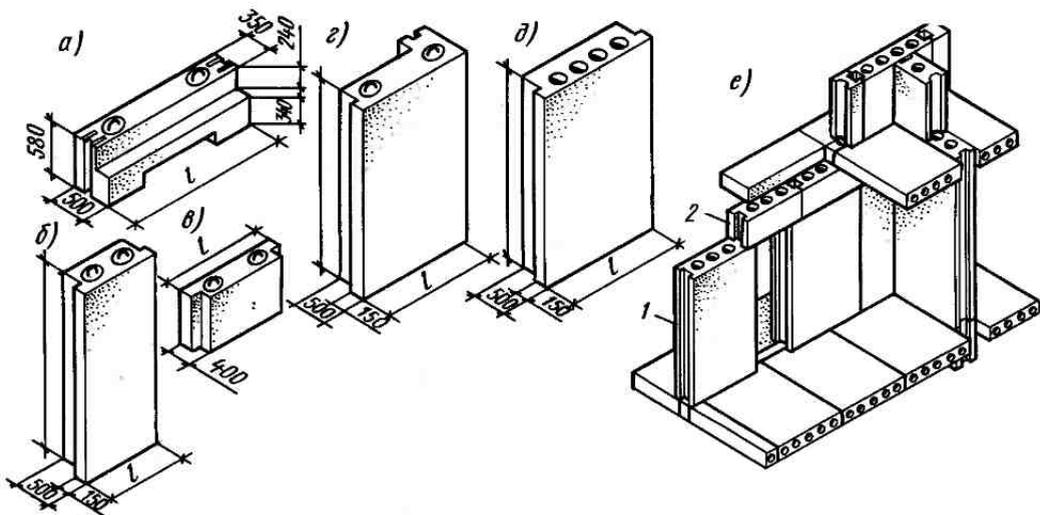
Типы крупных блоков стен жилых зданий:
